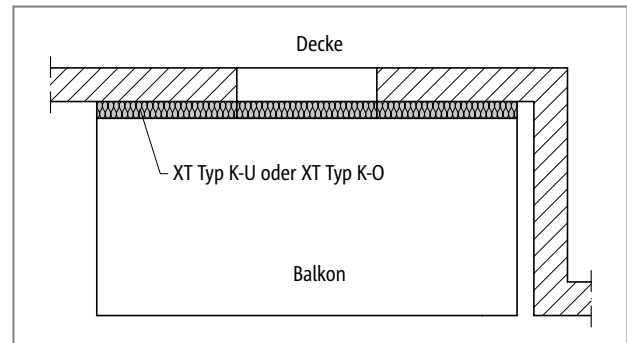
Schöck Isokorb® XT Typ K-U/K-O: Balkon bei Fassadenversprung
